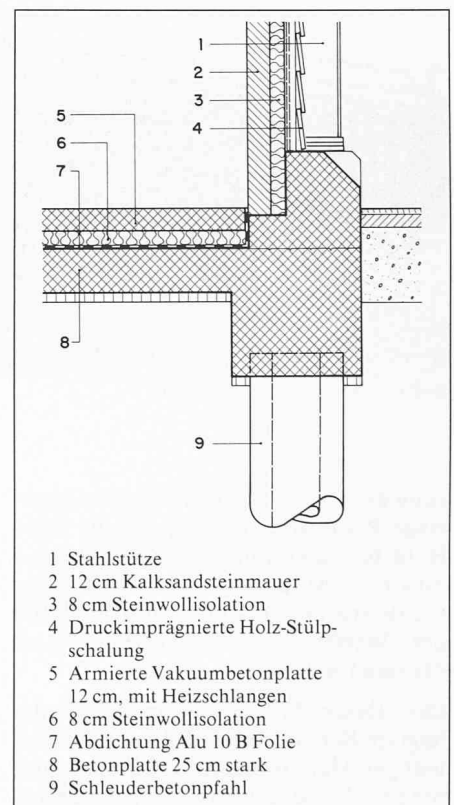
Fassaden- und Bodendetails Betriebsgebäude
